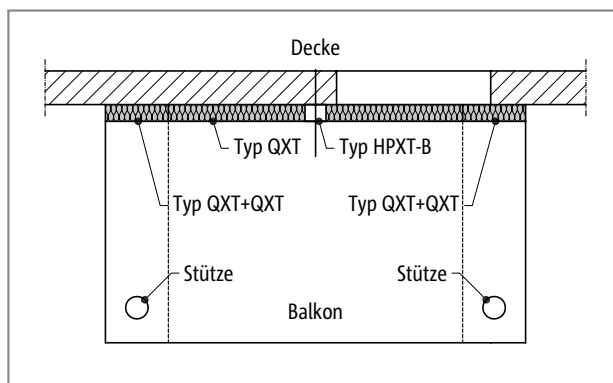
Schöck Isokorb® tipo QPXT+QPXT e tipo QXT: balcone con appoggio su pilastri, collegamento con diversi gradi di rigidità dell'appoggio
